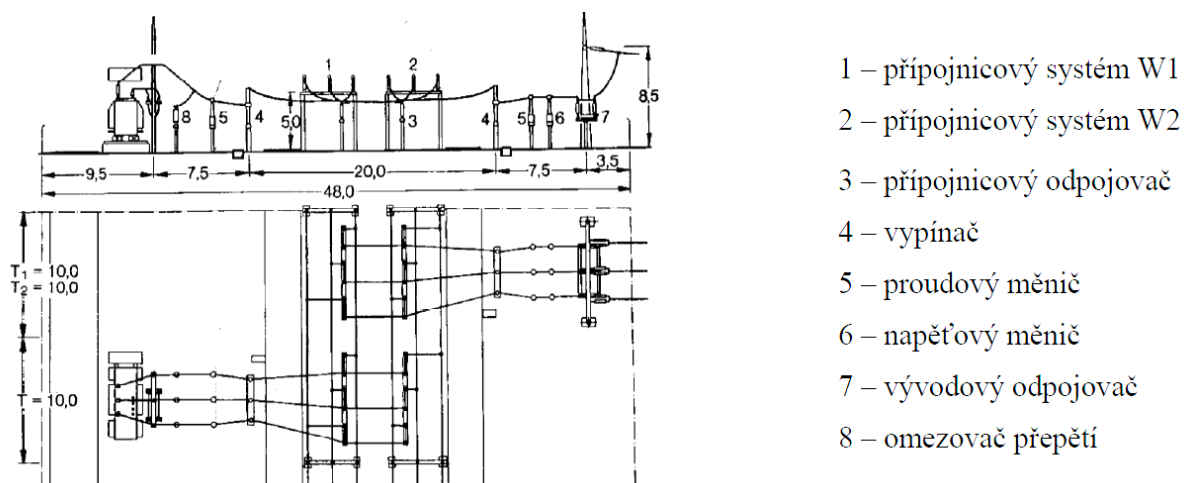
Tandemové uspořádání rozvodny 110 kV [2]
